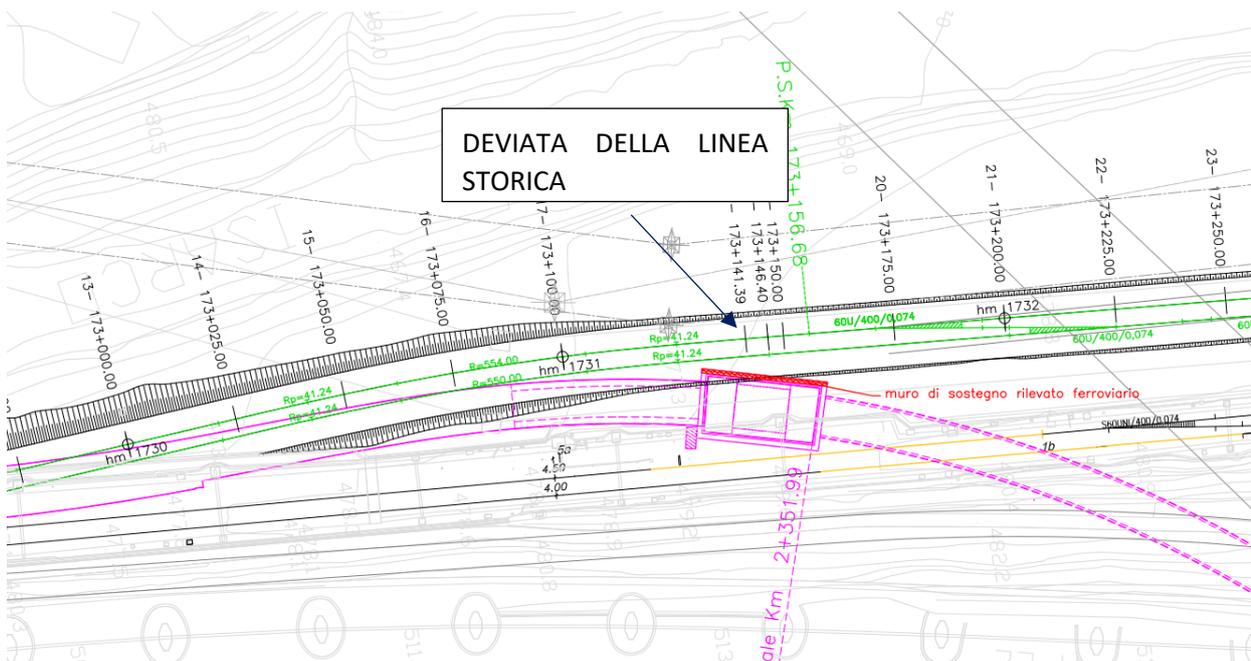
Sottoattraversamento linea storica: Progetto definitivo
